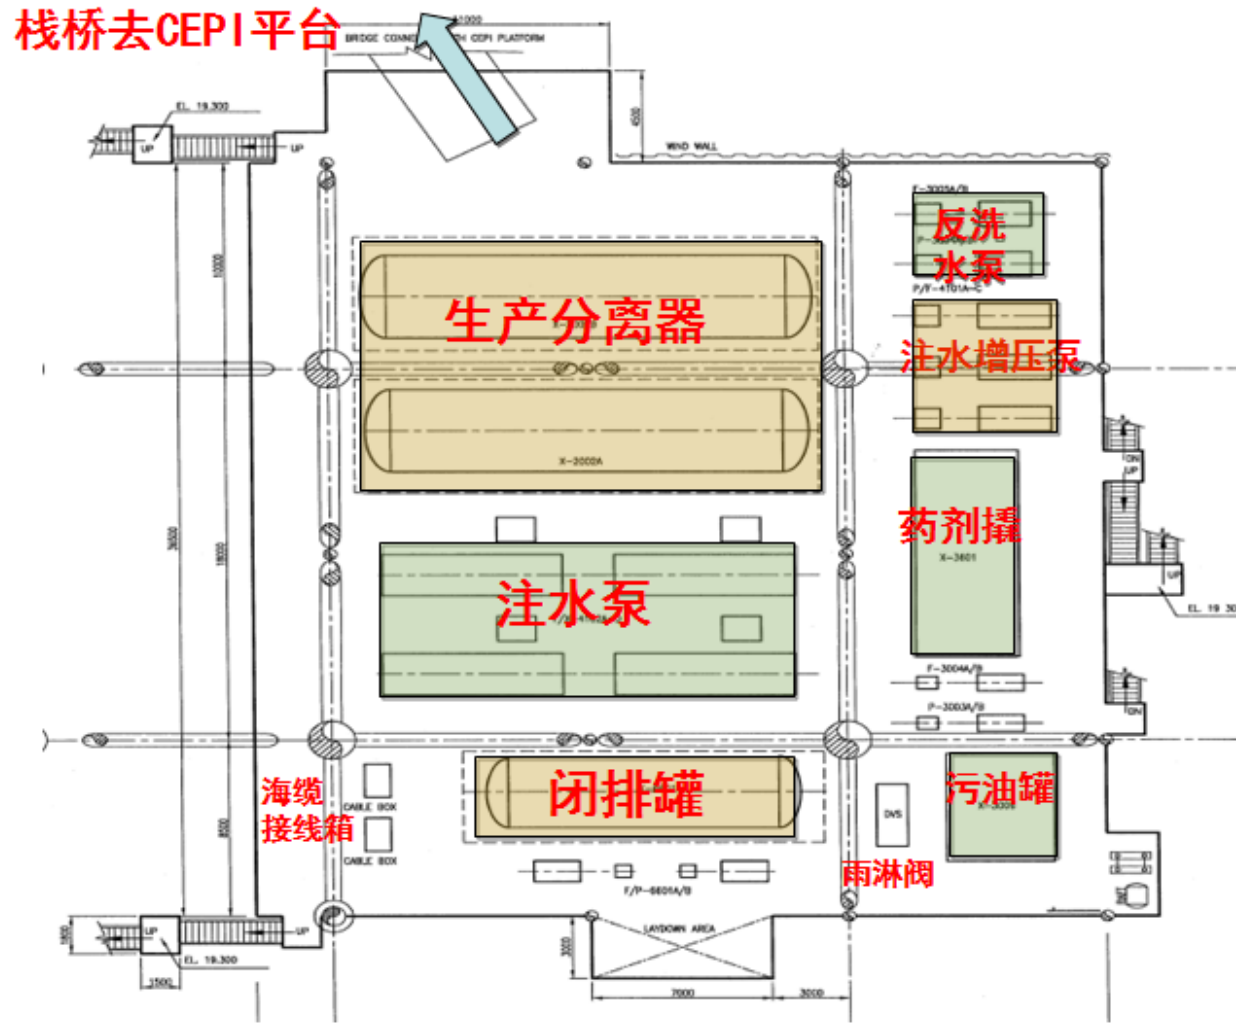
QHD32-6CEPK 下层甲板平面布置图
